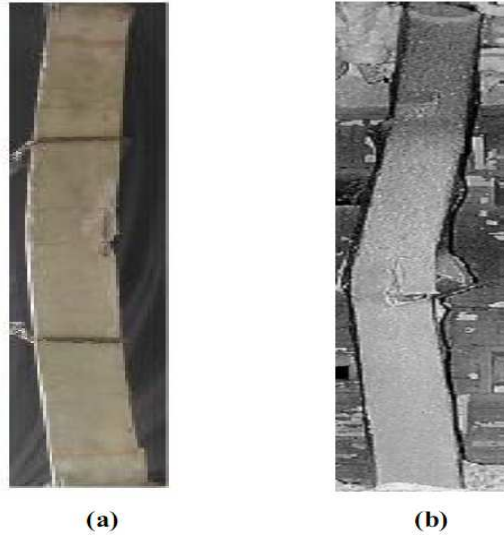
Flambement des poteaux mixtes : (a)- Profil d'acier enrobé de béton
